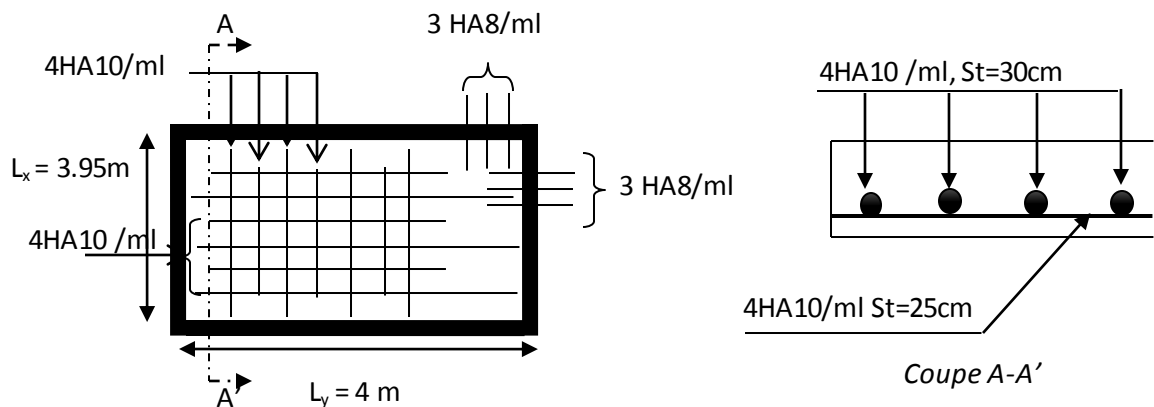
Schéma de ferrailage Dalle pleine sur quatre.
